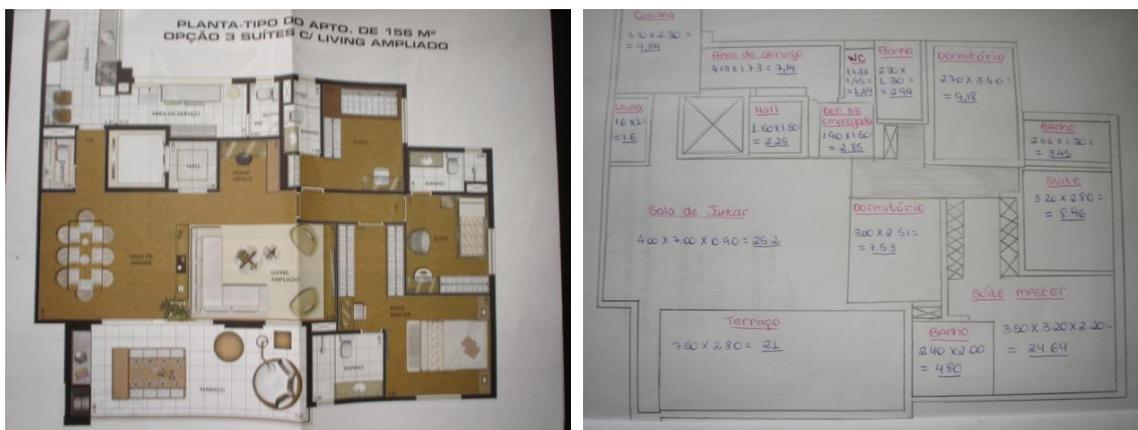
Plantas baixas de imóveis em escala e cálculo de áreas
